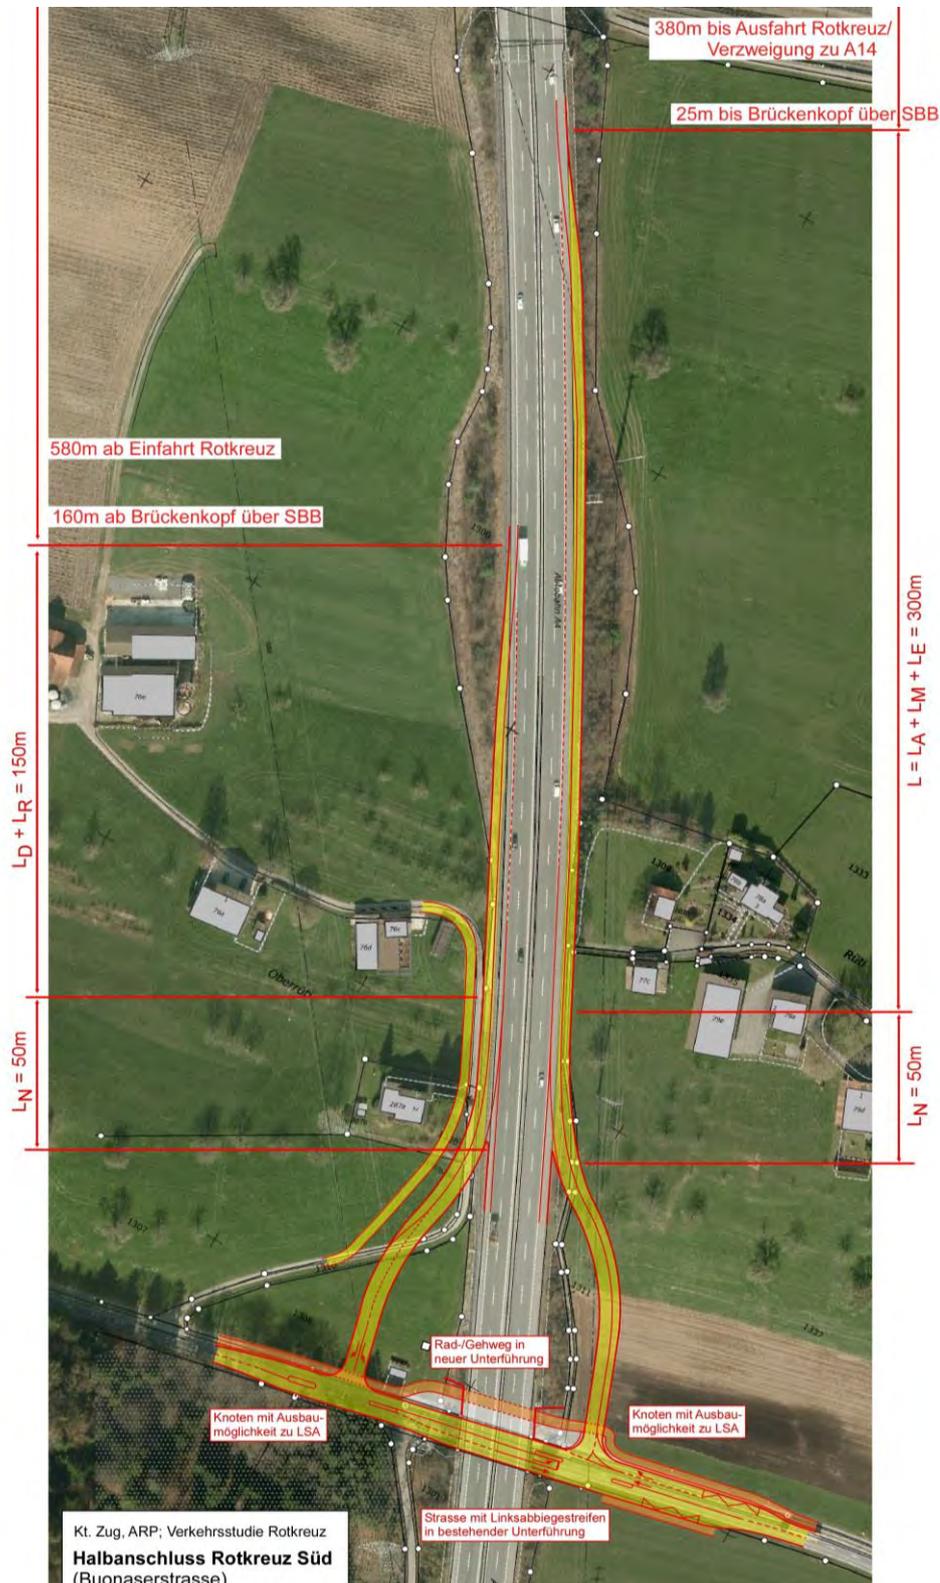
Planskizze Halbanschluss A4 Buonaserstrasse
